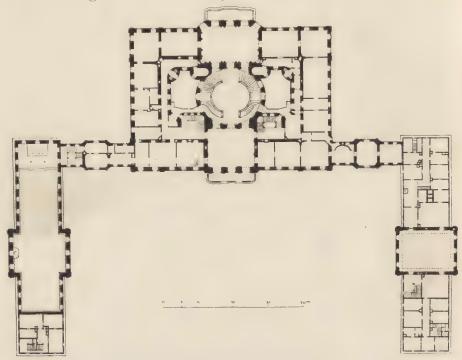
Schloss Bruchfal. Grundriss des Hauptgeschosses.
